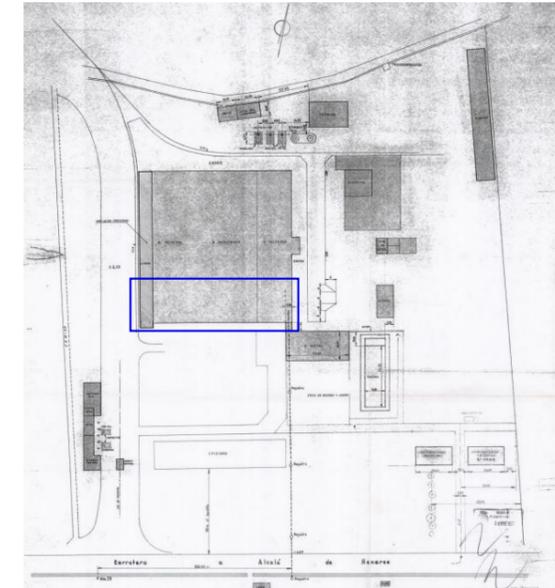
Plano de emplazamiento. En azul el elemento subsistente actual
